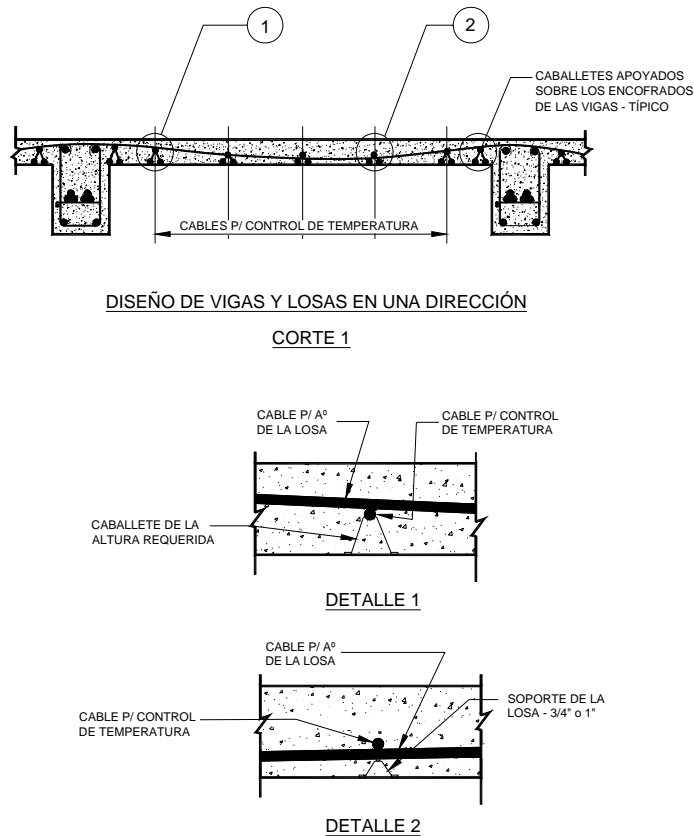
Detalles para utilizar cables no adherentes como armadura de contracción y temperatura en las construcciones con vigas y losas en una dirección
